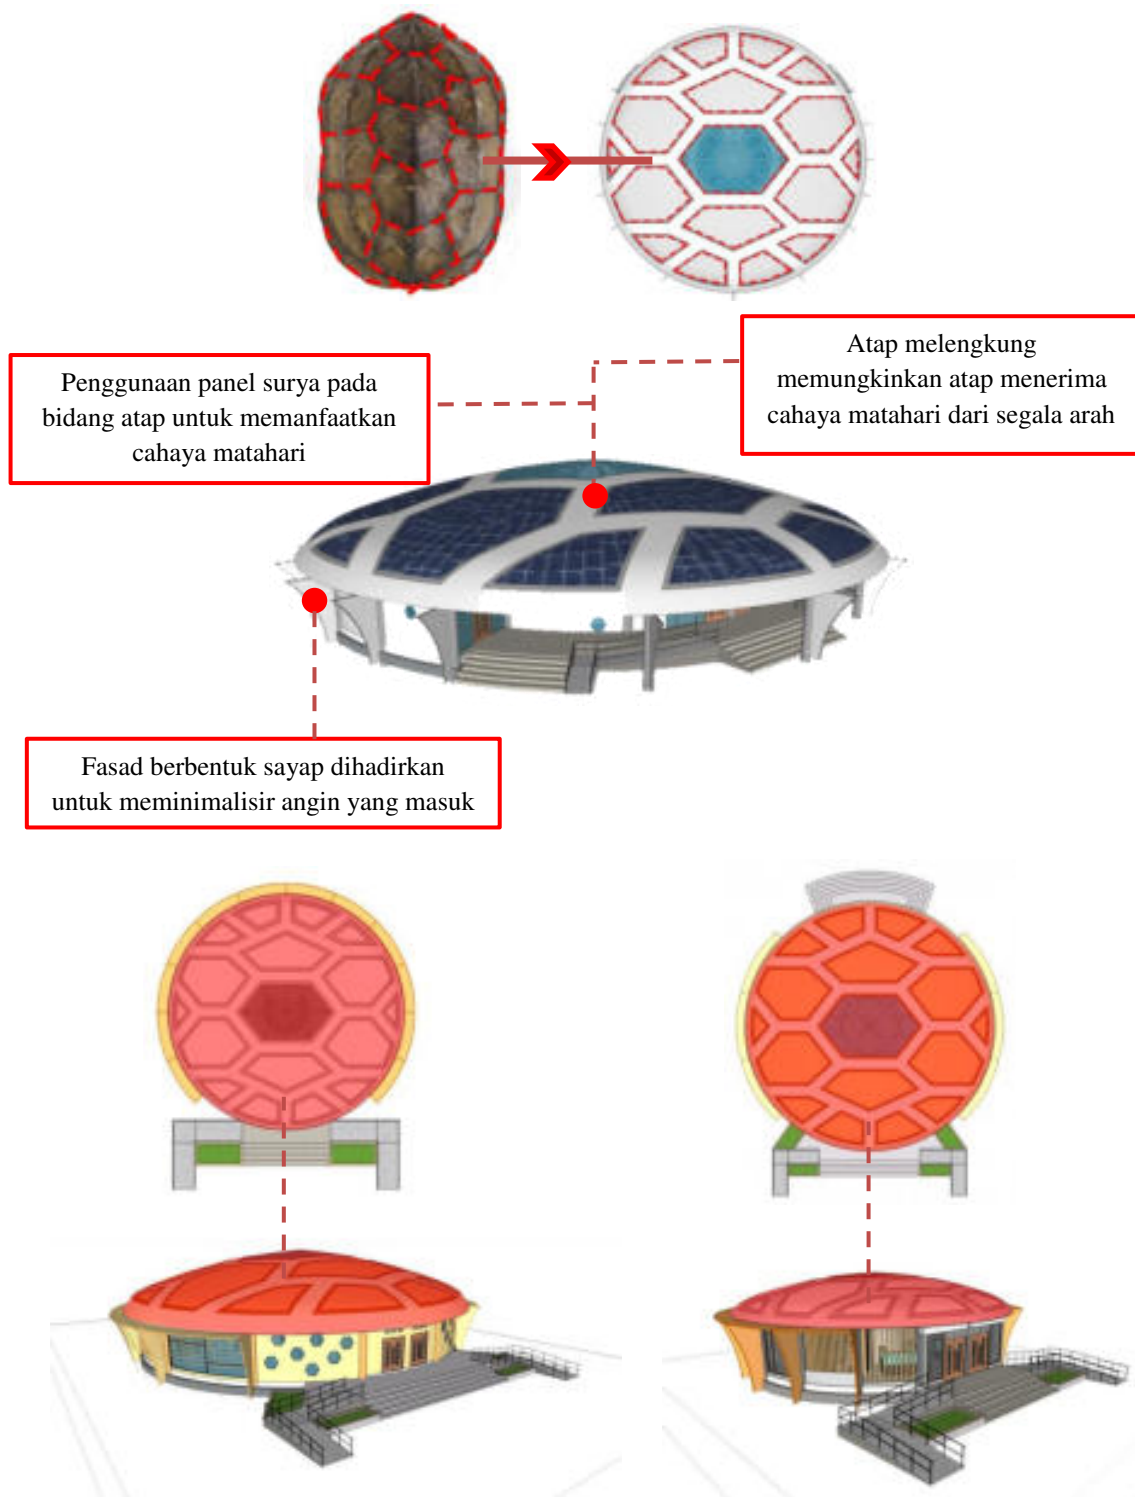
17 Olahan bentuk pada layout bangunan utama
